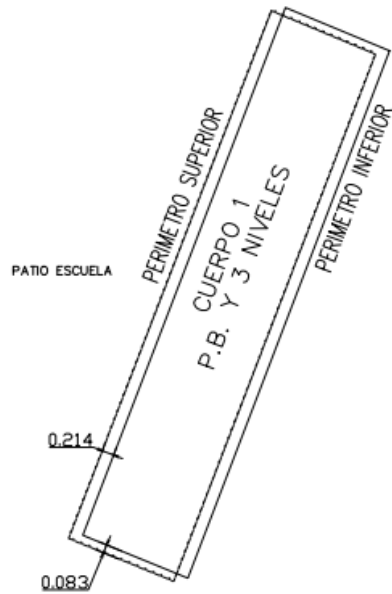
Vista en planta de los perímetros del edificio. (GACONSA, 2018)
